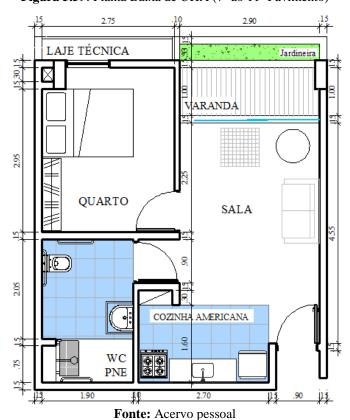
Planta Baixa de UHA (7º ao 11º Pavimento)
